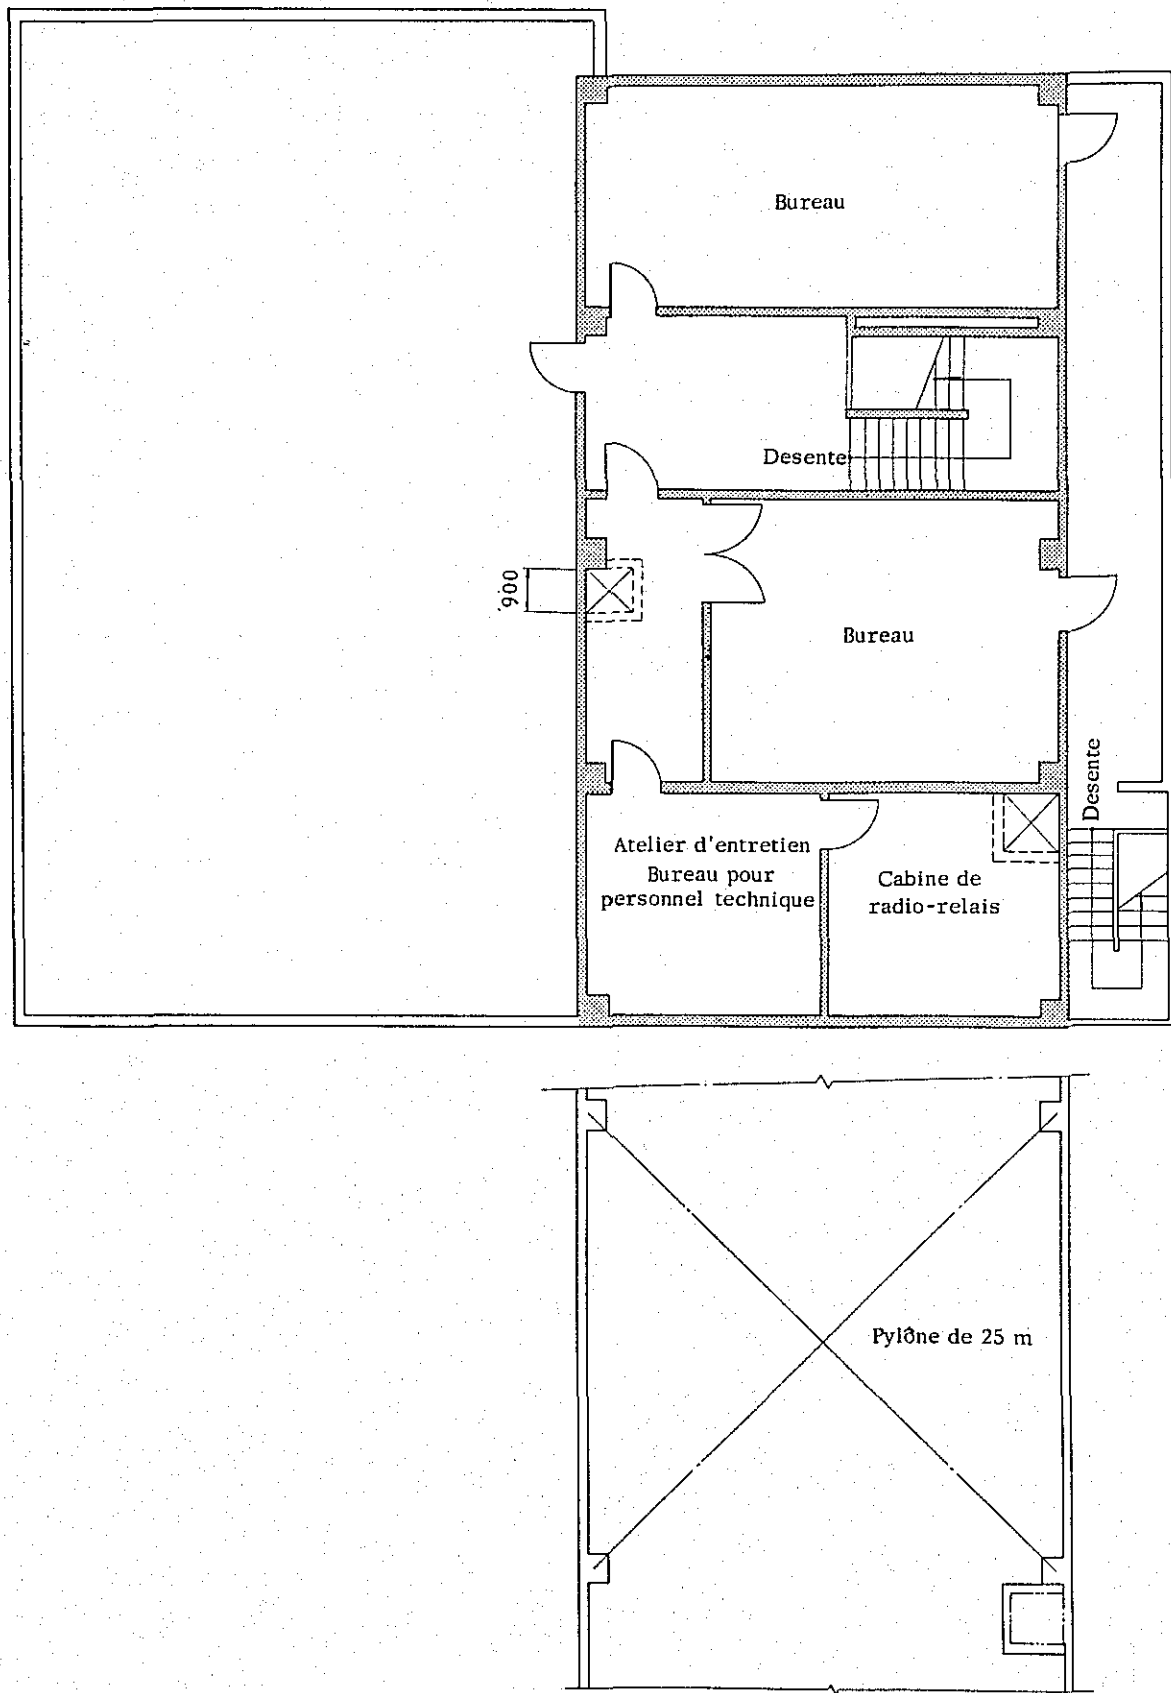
PLAN DE TRACE D'UN NOUVEAU BATIMENT DU STUDIO DE RADIO - PLAN DU 3E ETAGE ET DU TOIT
